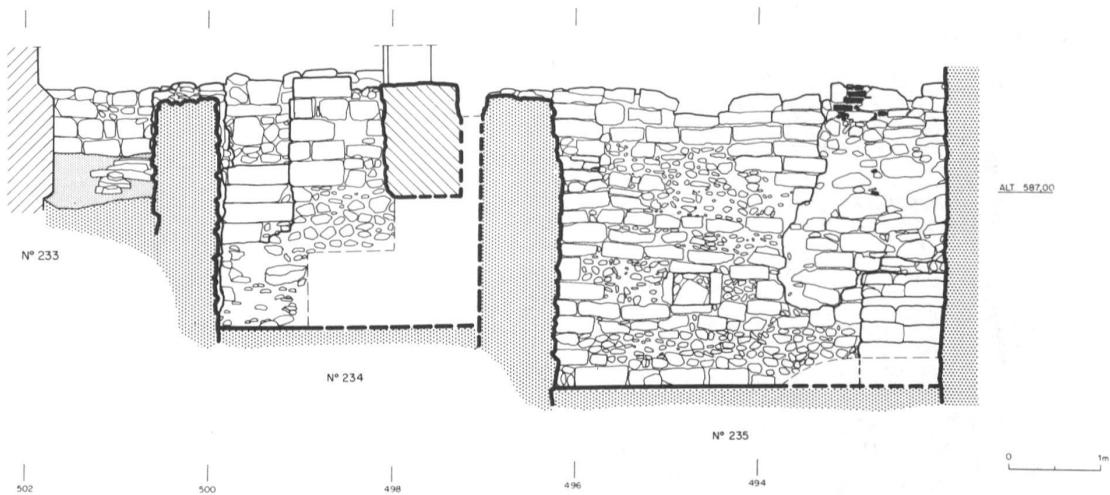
Rue du Pont-Suspendu 74–75. Relevé au pierre à pierre de la face interne de la façade nord des n° 232–234.
